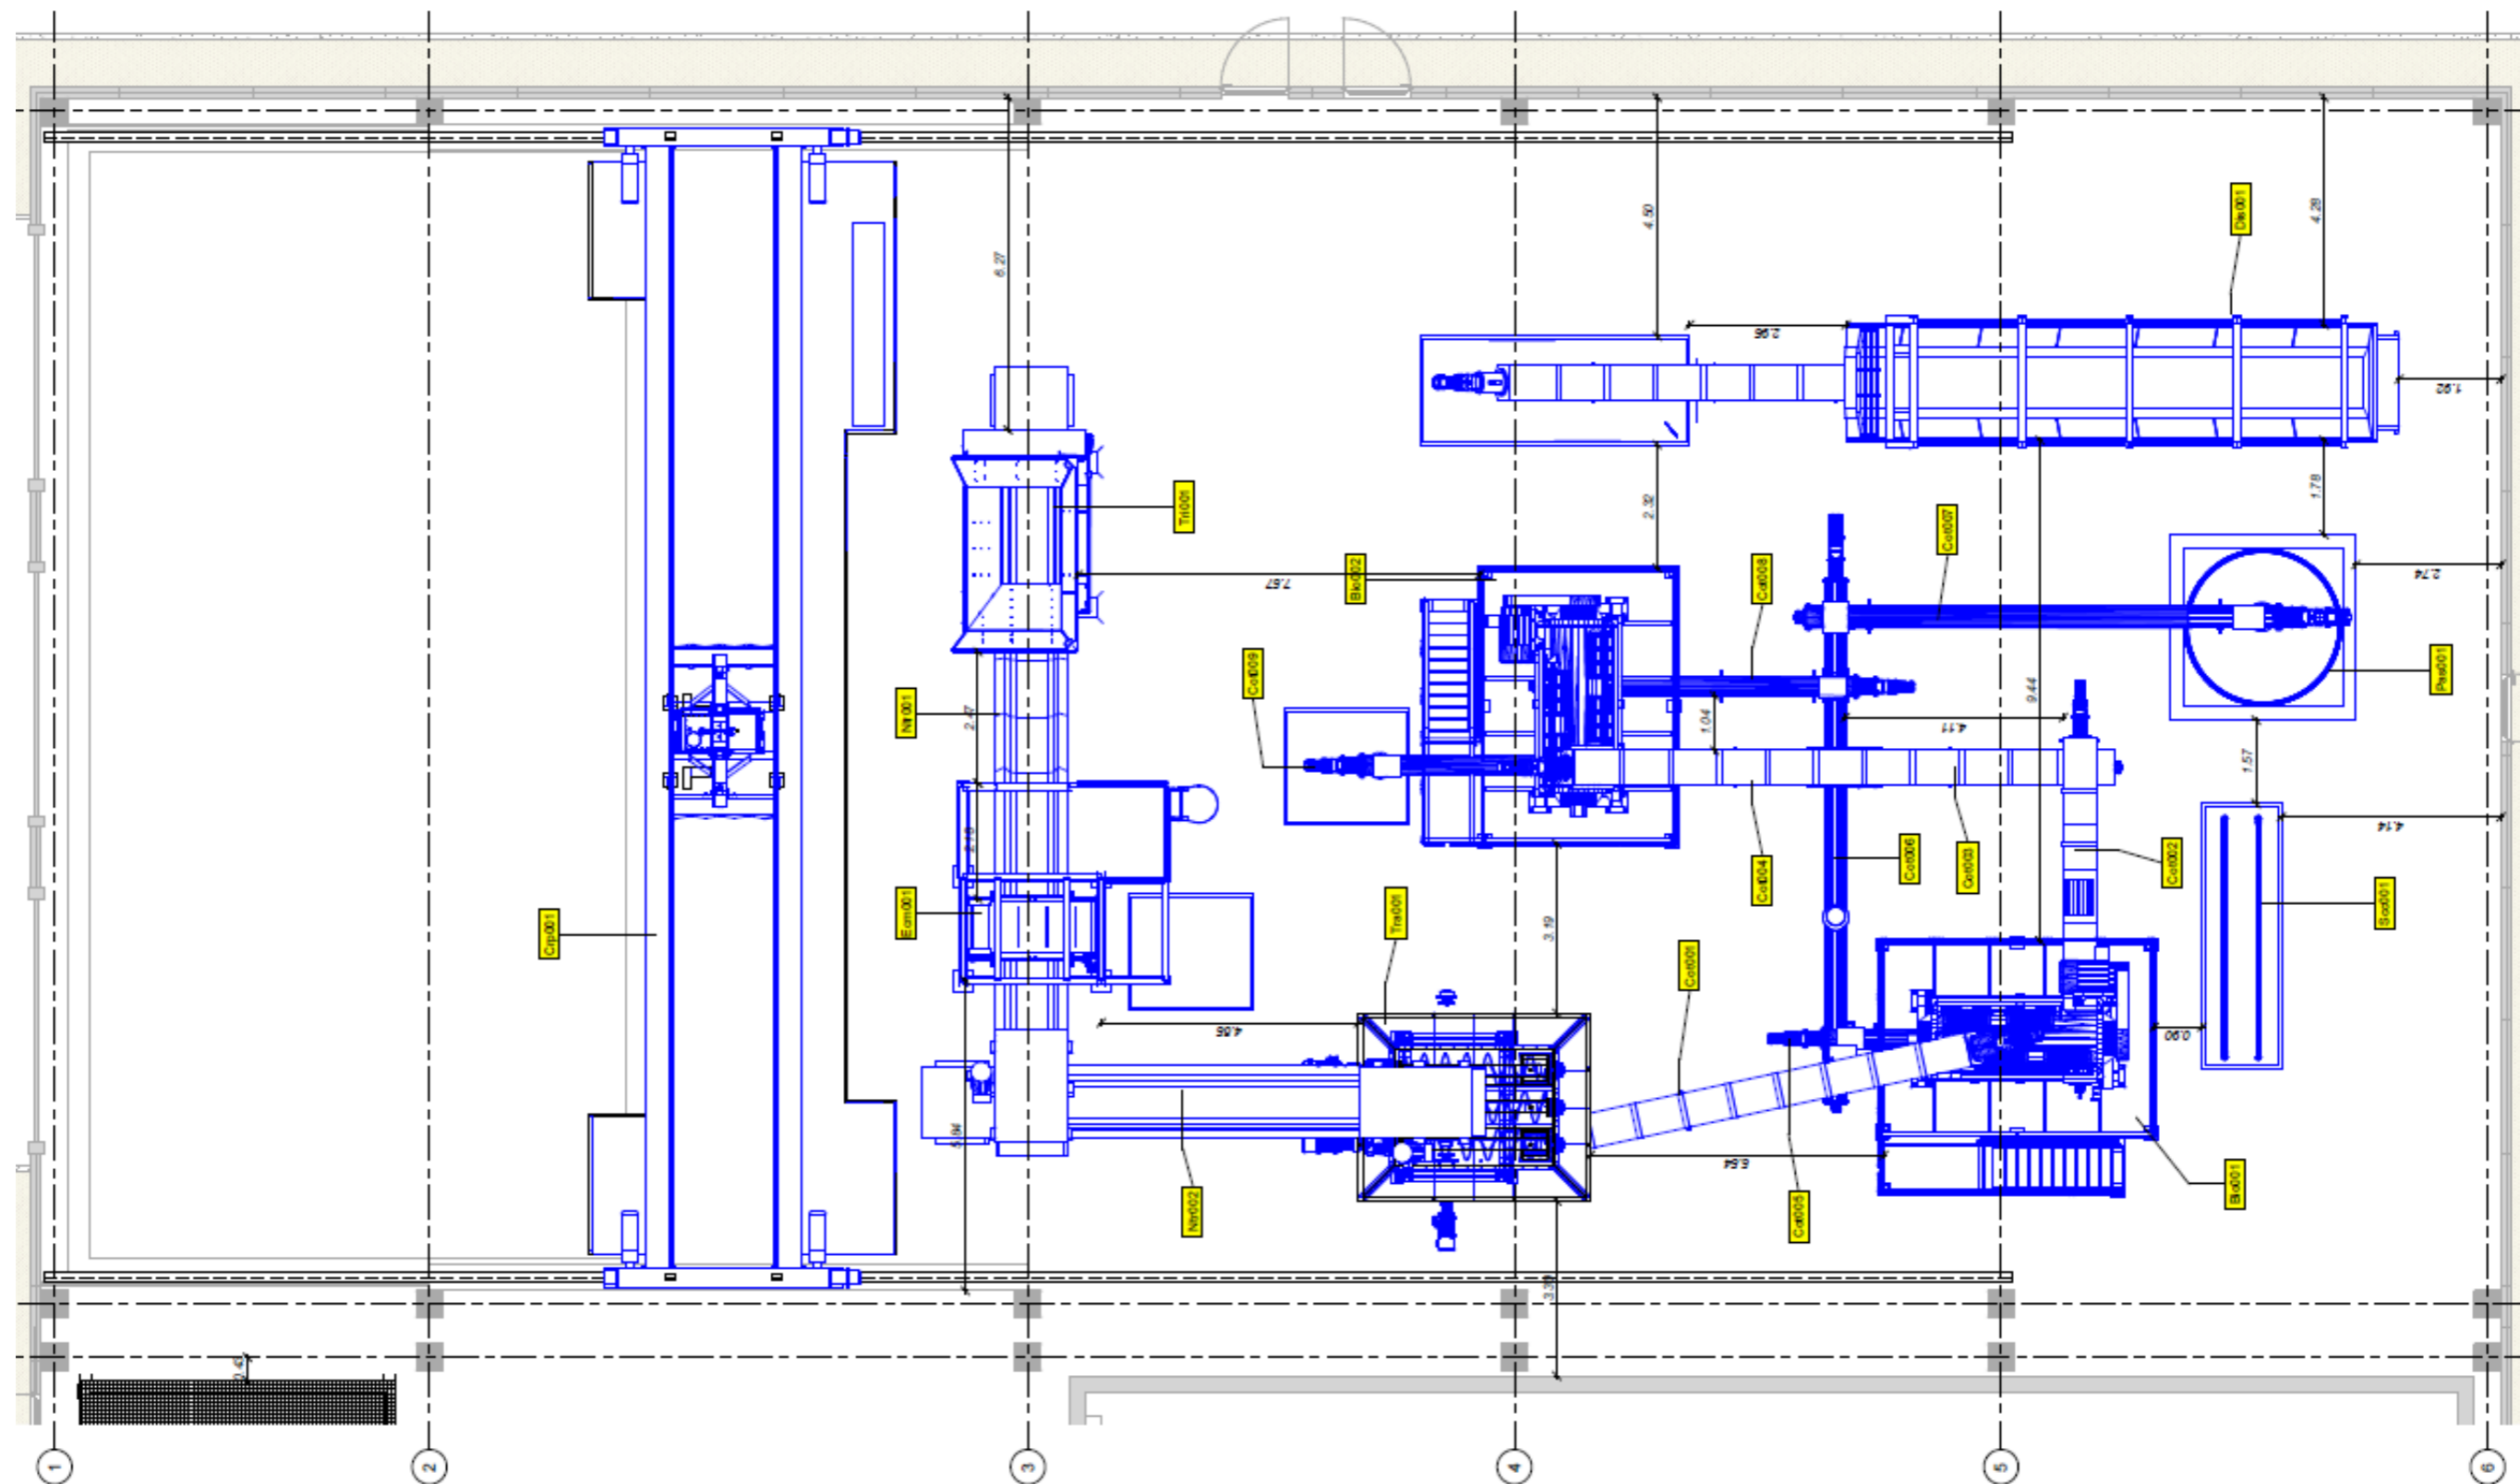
ESE.EGR.OEM.002 planimetria area di ricezione e pretrattamento
